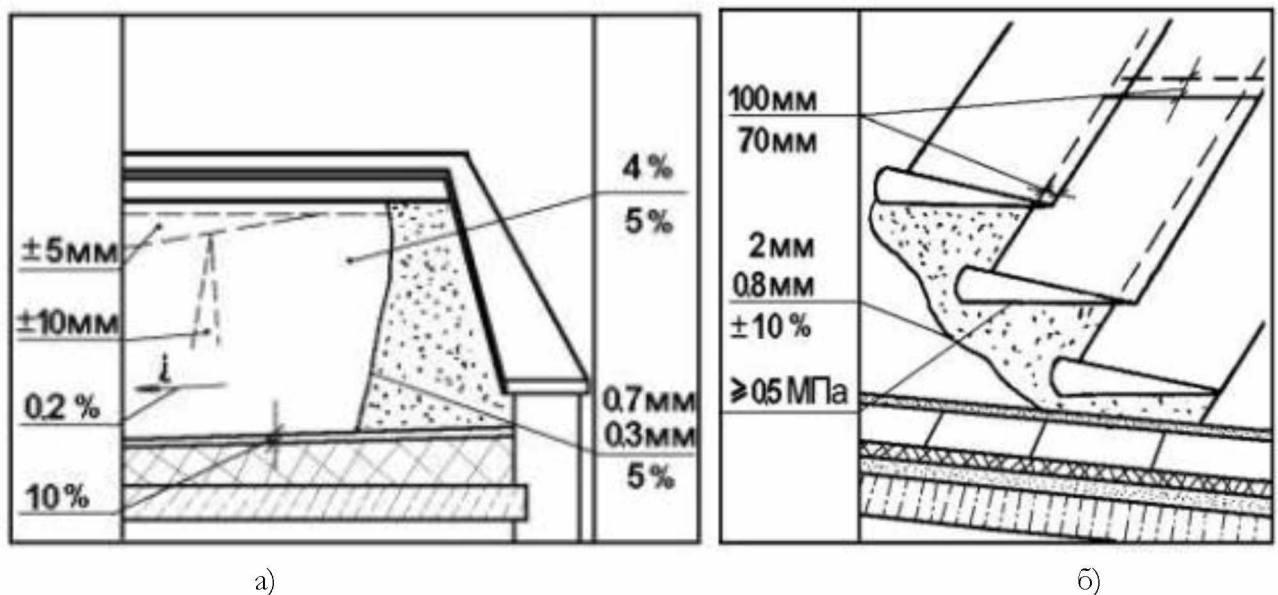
Основные допуски при приемке основания и покрытия кровли.
